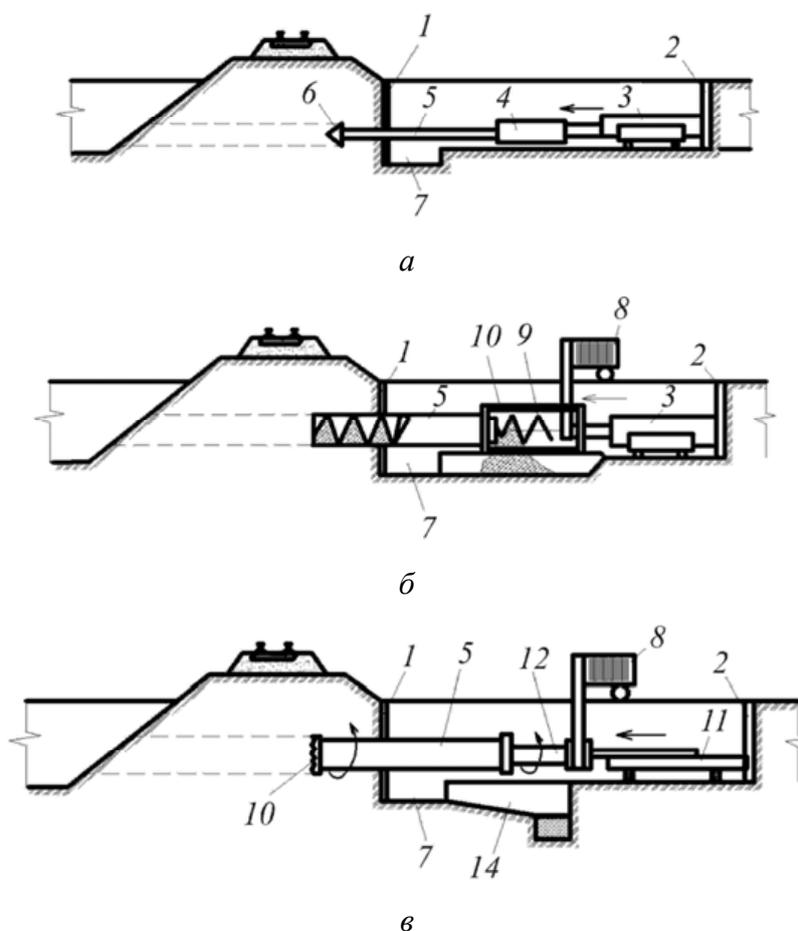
Схемы разработки грунта бестраншейным методом: *а* — прокалывание; *б* — продавливание; *в* — горизонтальное бурение: 1 — крепление передней стенки рабочего котлована; 2 — упор, устанавливаемый на задней стенке рабочего котлована; 3 — гидравлический домкрат; 4 — шомпол; 5 — труба; 6 — конический наконечник; 7 — приямок для наращивания трубы; 8 — привод; 9 — шнековое устройство для извлечения грунта из трубы; 10 — рама, передающая давление; 11 — речный домкрат; 12 — вращающийся шпindel; 13 — режущая коронка; 14 — лоток и приямок для пульпы
